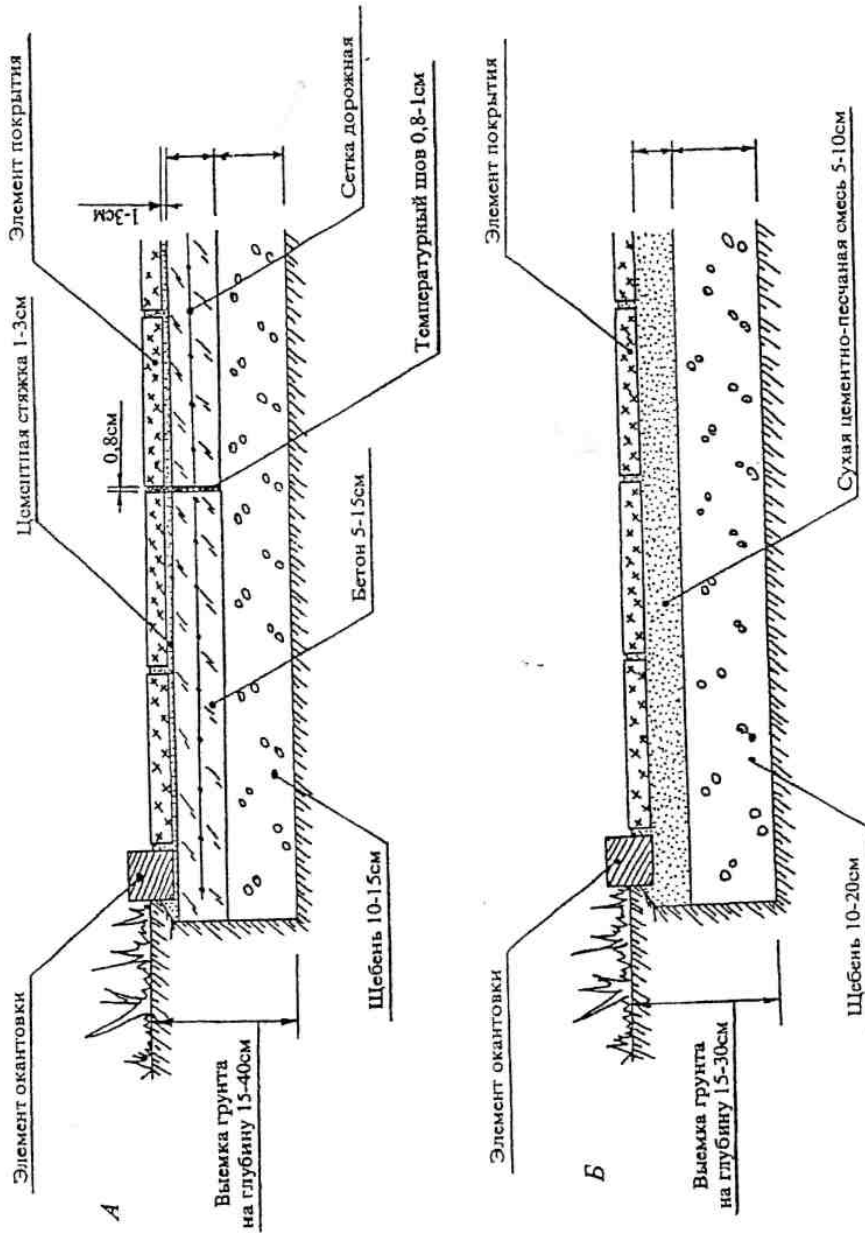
Конструкция садово-парковых дорог из плит (окаймление – садовый бортовой камень, поребрик):
